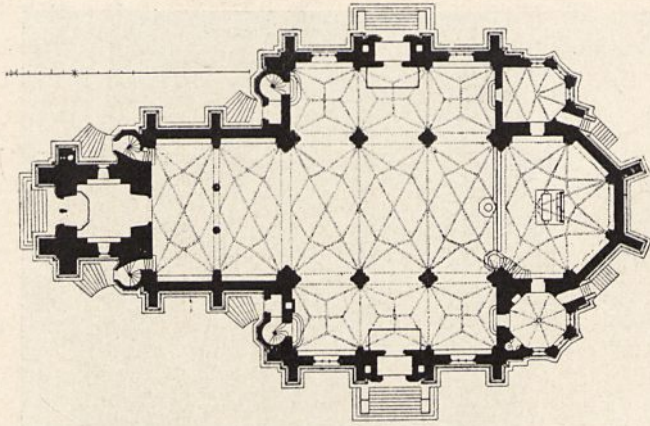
Dreikönigskirche in Frankfurt a. M. Grundriß.
